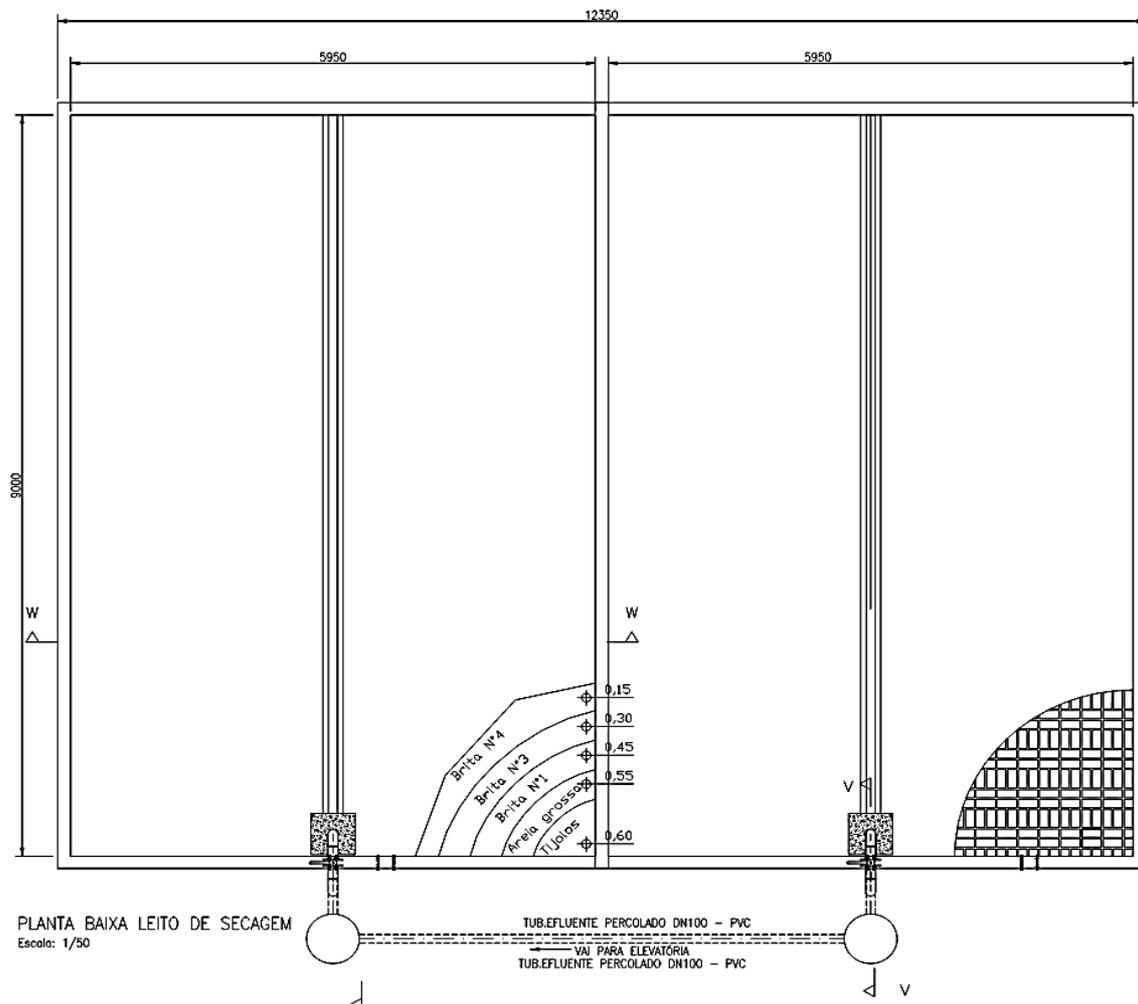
Planta baixa do Leito de Secagem a ser instalado.
